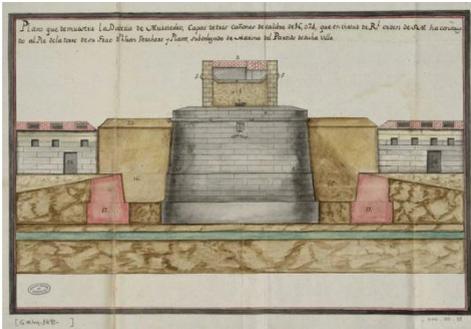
Plano de 1781 en donde se muestra el alzado de la batería de Murviedro, torre, foso y almacenes (A.G.S. MPD, 50, 088)
